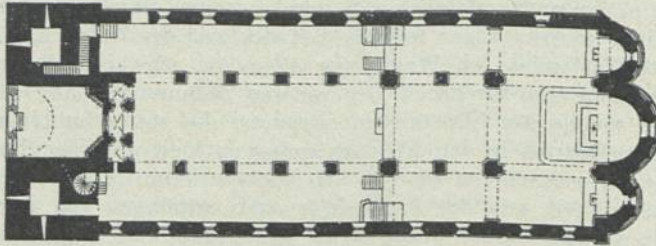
Grundriss einer romanischen Basilika (Dom zu Gurk)
